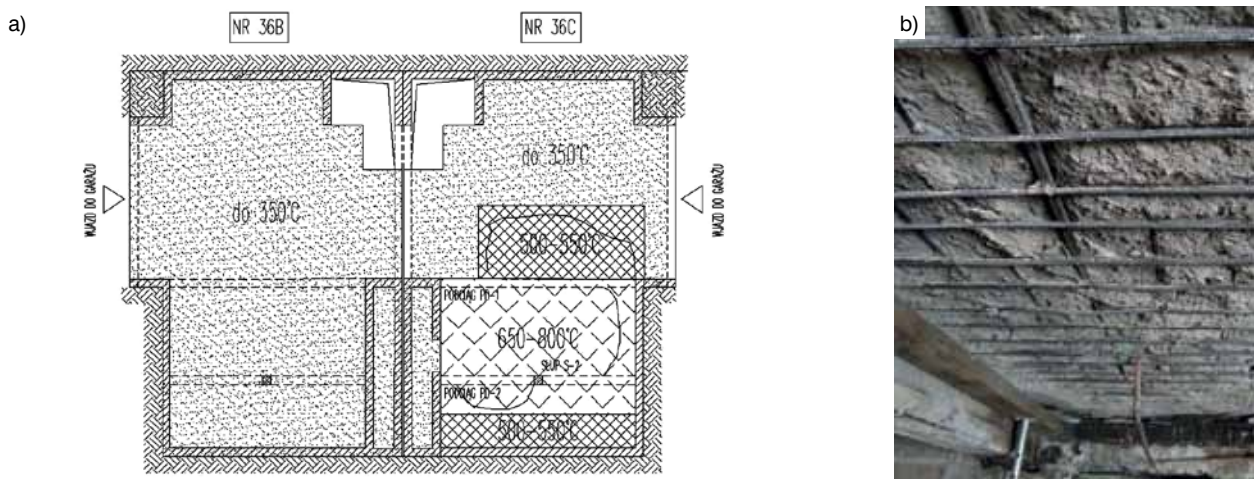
Widok uszkodzeń konstrukcji żelbetowej i ścian murowanych w garażu budynku nr 36C
